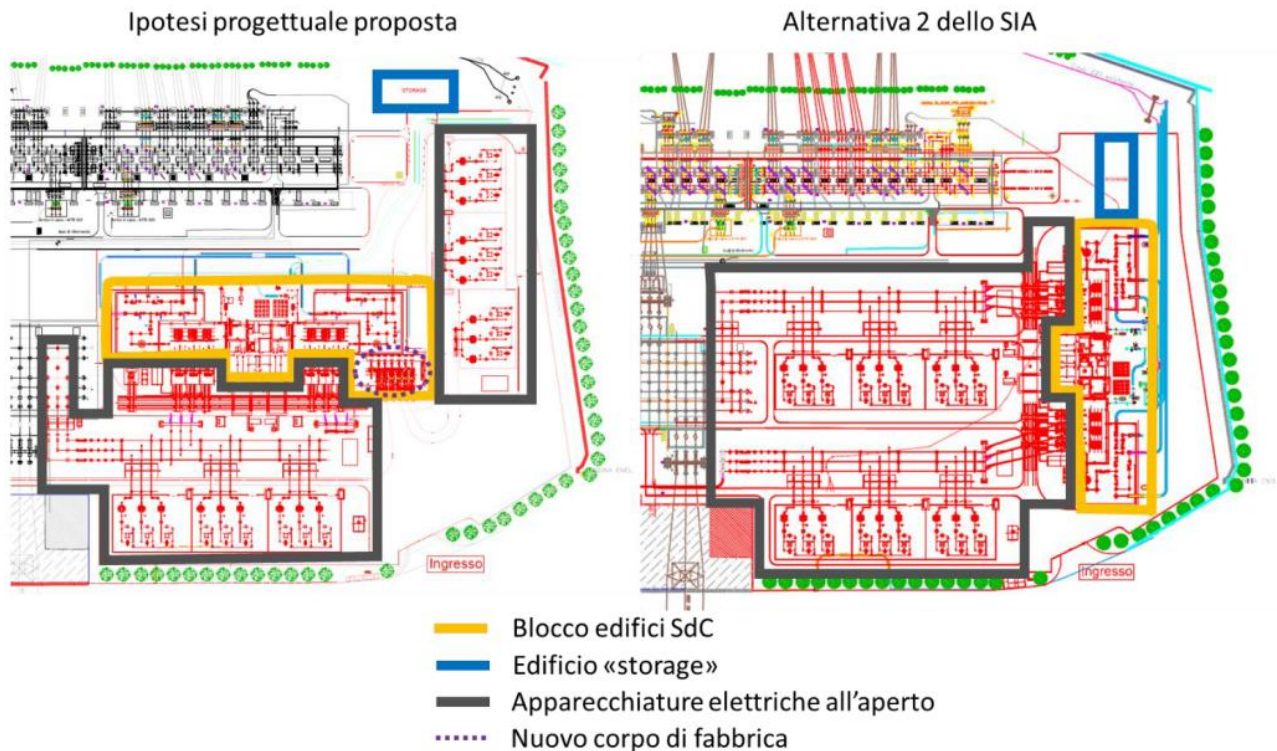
Confronto tra la configurazione interna dell'impianto nell'ipotesi progettuale proposta come Alternativa 2 (a sinistra) e nell'ipotesi proposta come Alternativa 2 nel SIA del 2019 (a destra)
